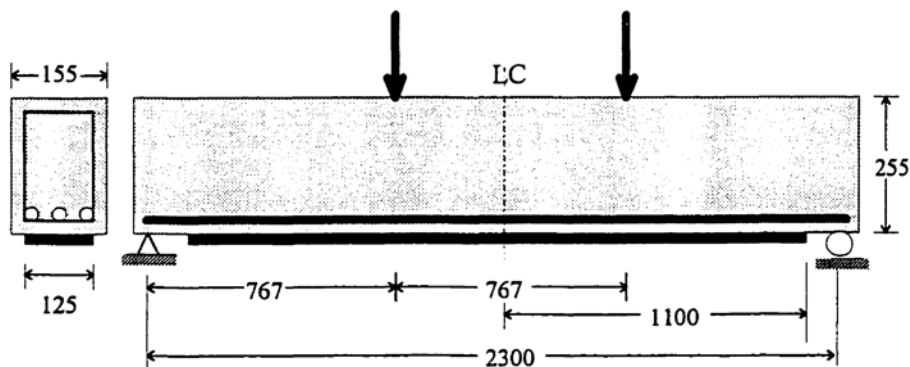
Poutre en béton armé renforcée à l'aide d'une plaque d'acier [dans 12].
